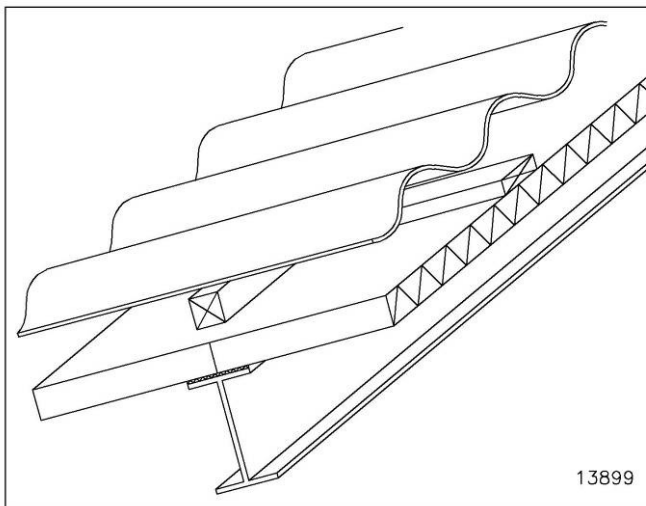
Plaque ondulée fixée sur une structure sur l'isolant
